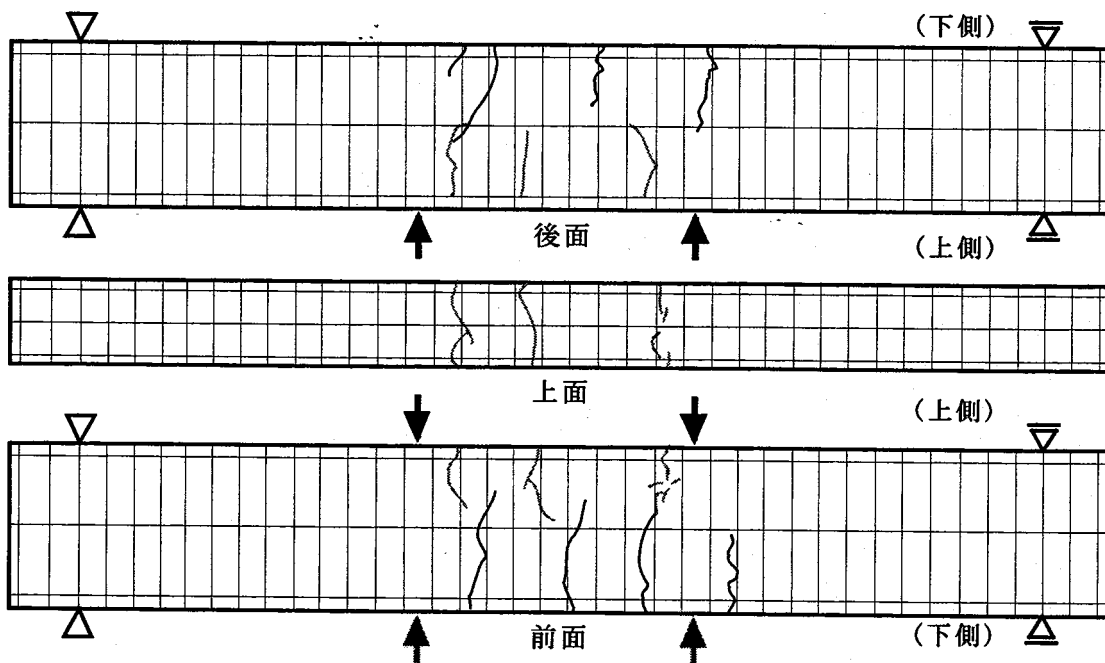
a) ひび割れ性状 [BS-4 ; R = 1/1600rad.]
